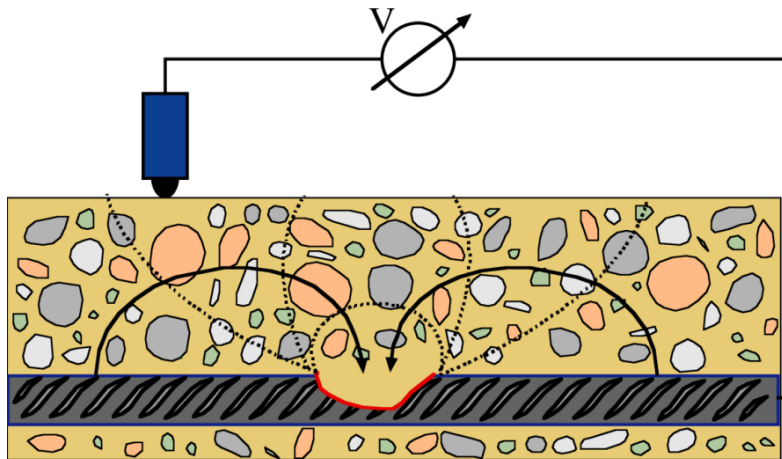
Messaufbau zur Bestimmung des Bewehrungspotentials. Der Ionenstrom im Beton (durchgezogene Linie) führt zu einem Spannungsabfall (gestrichelte Linie), der an der Betonoberfläche gemessen werden kann [314].
